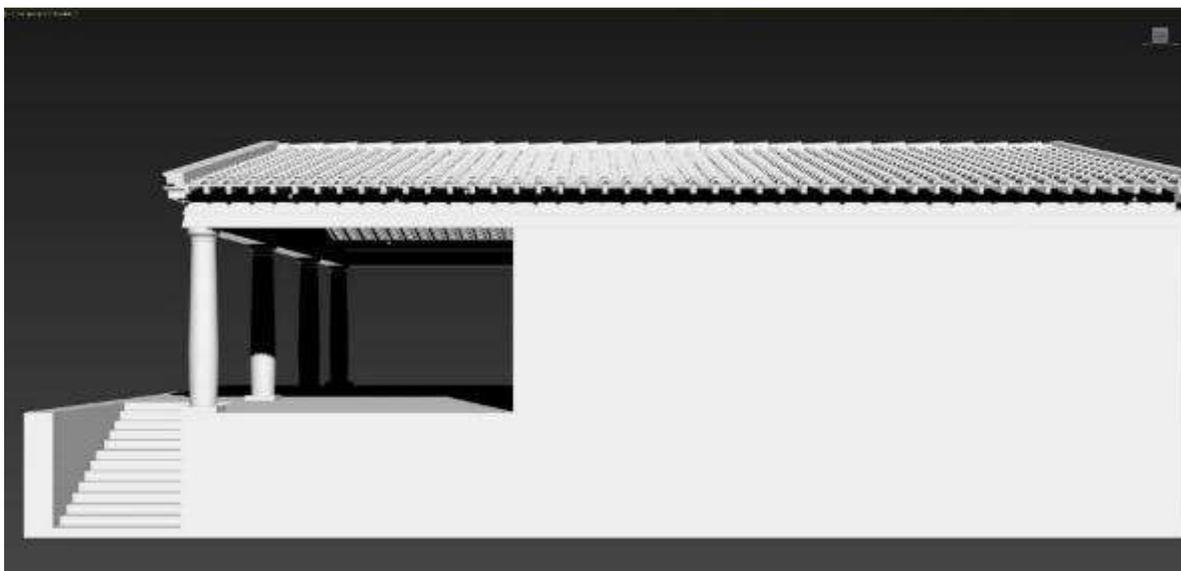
il tempio maggiore, prospetto laterale Nord.
